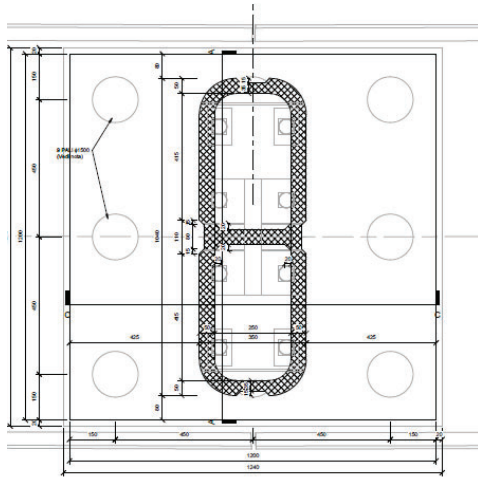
Pianta delle fondazioni delle pile e delle spalle
